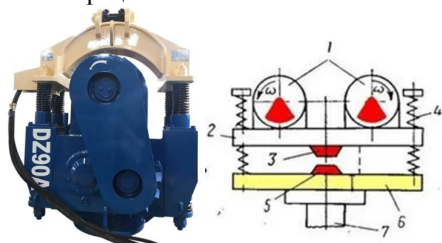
Вибромолот: а- общий вид; б- принципиальная схема, 1- электродвигатель с дебалансами; 2-ударная плита; 3-боек; 4-пружина; 5-накавальня; 6-плита; 7-свая.
